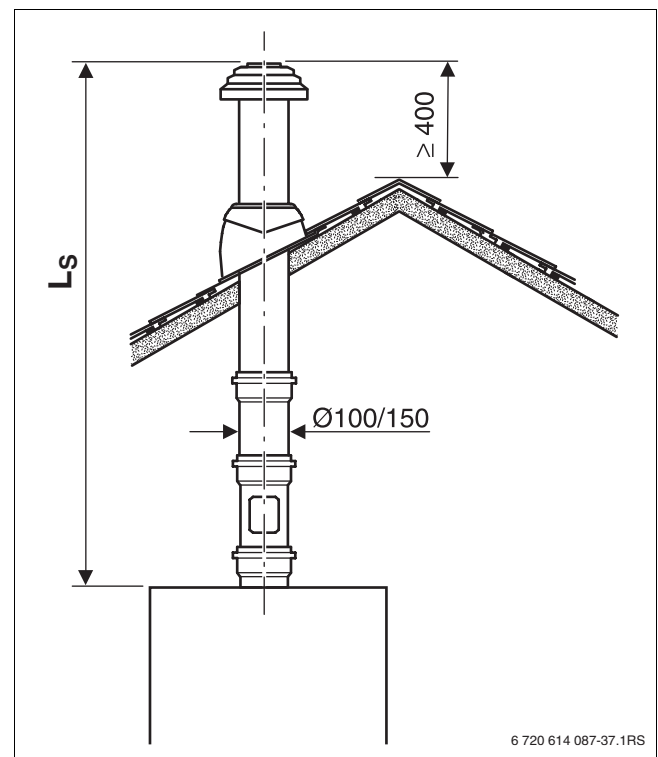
Doppelrohrführung senkrecht ($C_{33(x)}$)
